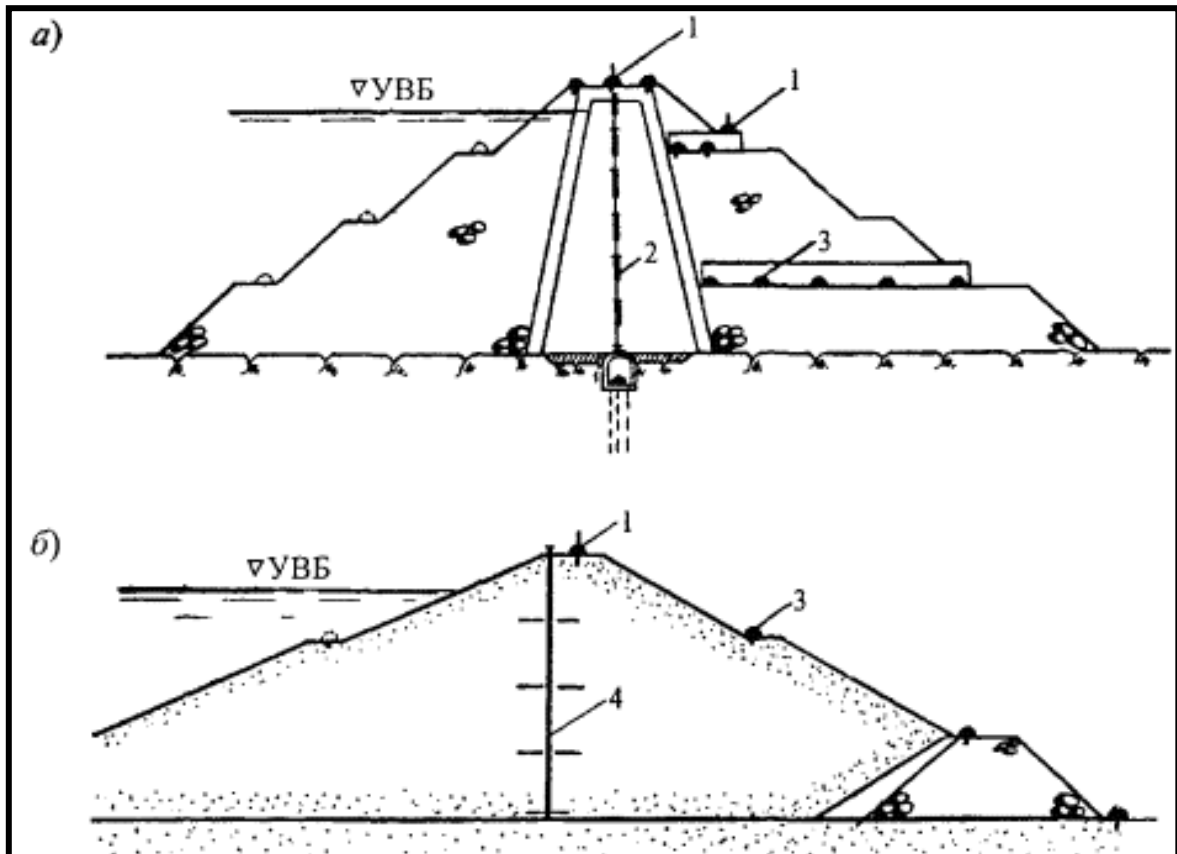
Схемы размещения геодезических марок на грунтовых плотинах:
